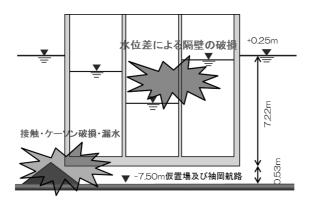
仮置場及び袖岡航標準断面図 (浮上・曳航時)
